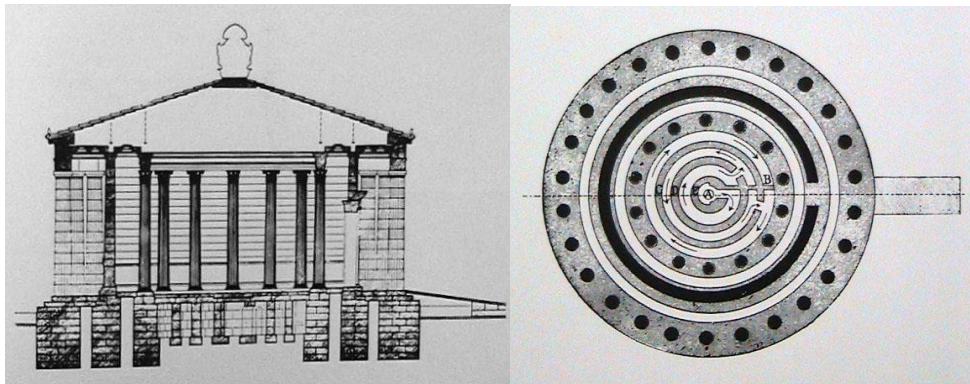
Tolos de Epidauro. Derecha: Vista en planta; Izquierda: Vista en sección-alzado. Fuente: Ilustración del autor de acuerdo a Kern, 2000, pág. 65
